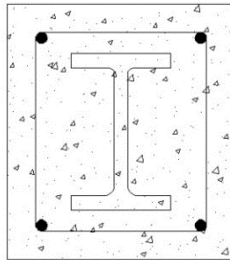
2 Balok Baja yang Diberi Selubung Beton
